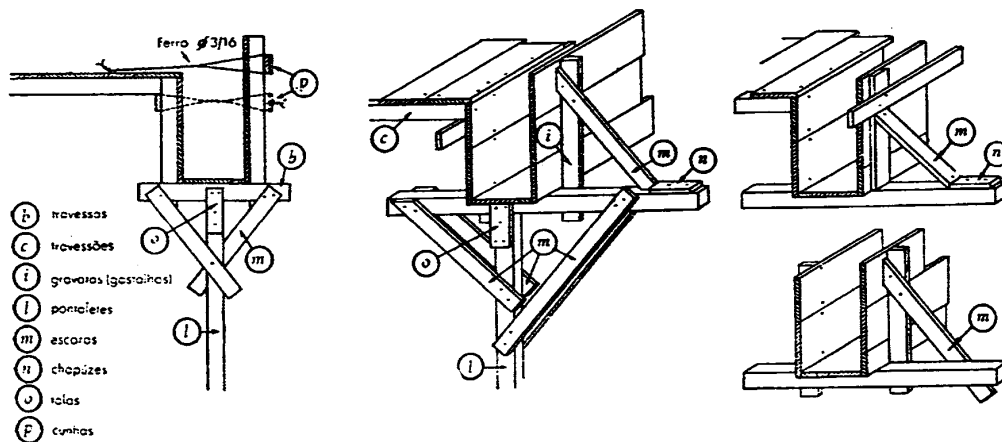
Detalhes de travessas e escoramentos (Fonte: ABCP, 1943).
